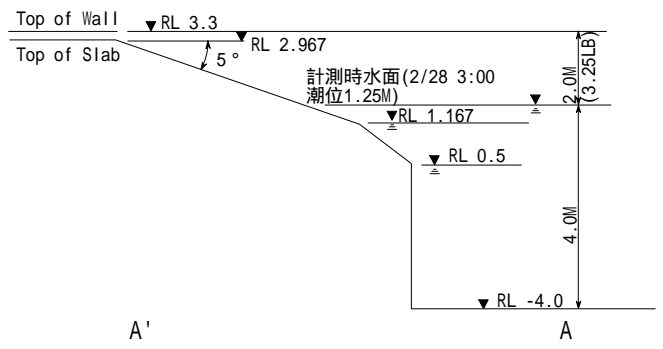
パンガイ埠頭断面図 (A-A' 断面)
